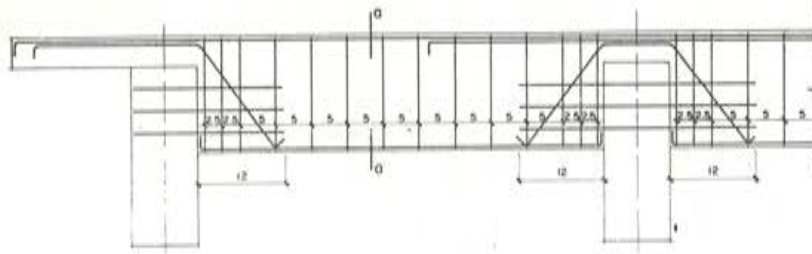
a).—Armaduras de las vigas extremas de arriostramiento.
